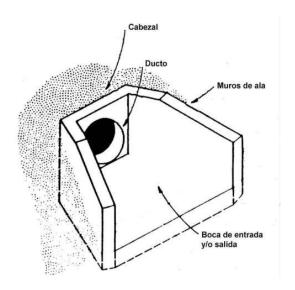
(m). Principales elementos que constituyen una alcantarilla.
